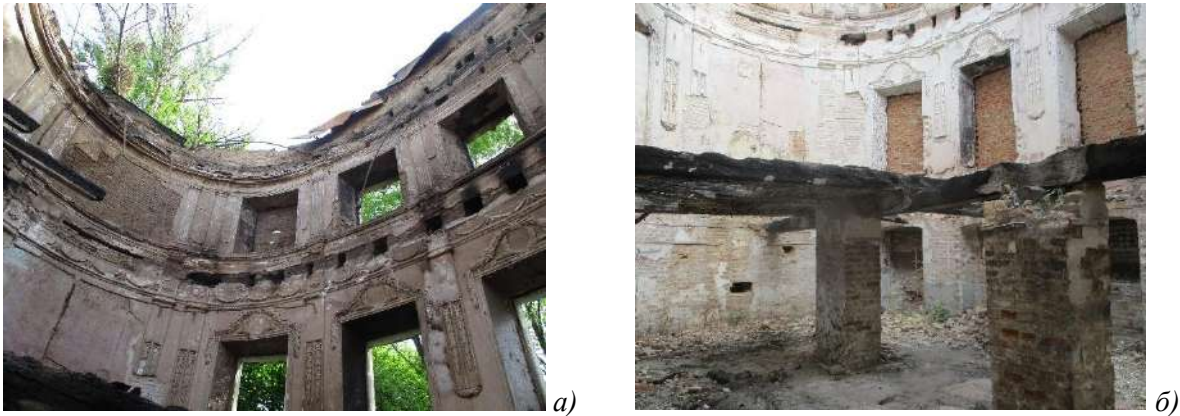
Дерев'яні конструкції будівлі «Палацу»: а) дах та перекриття знищені пожежею; б) перекриття над підвалом повністю згоріло.
